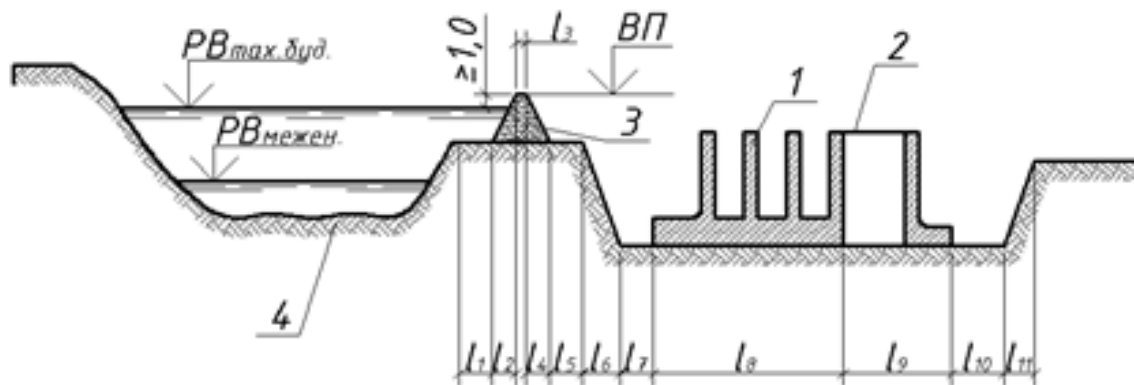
Схема розташування водоскидних споруд гідровузла на заплаві річки: 1 – водозливна гребля; 2 – будівля ГЕС; 3 – поздовжня перемичка; 4 – русло річки
